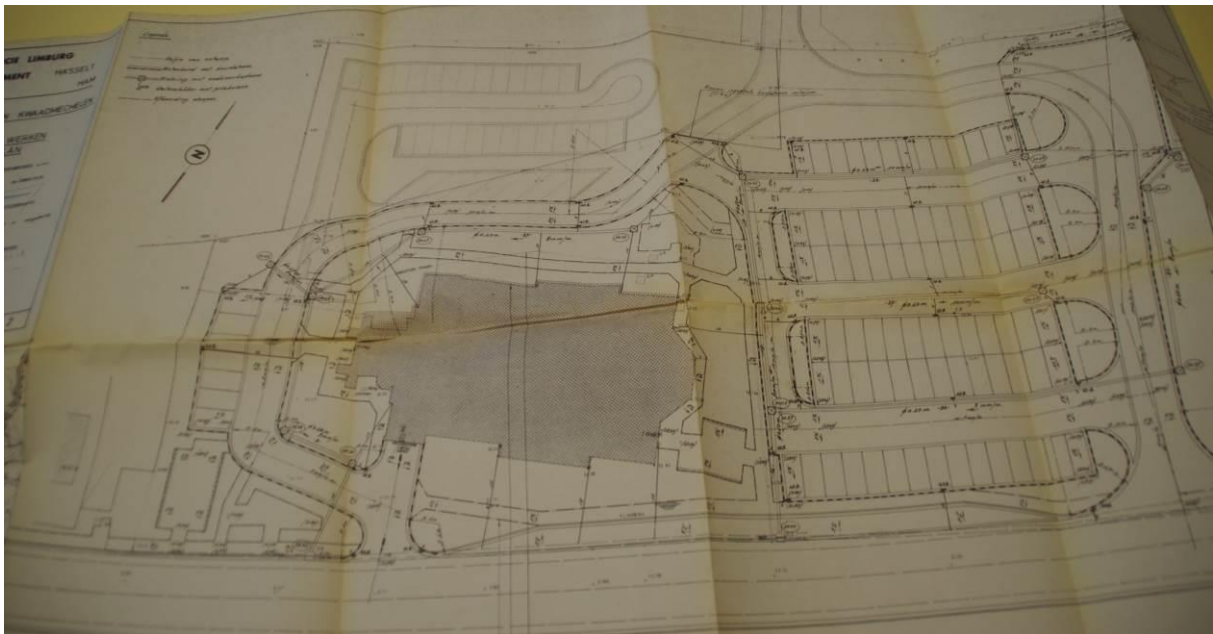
Detailplan met riolering, 1978. (Archief Technische Dienst Ham, 851.1)
